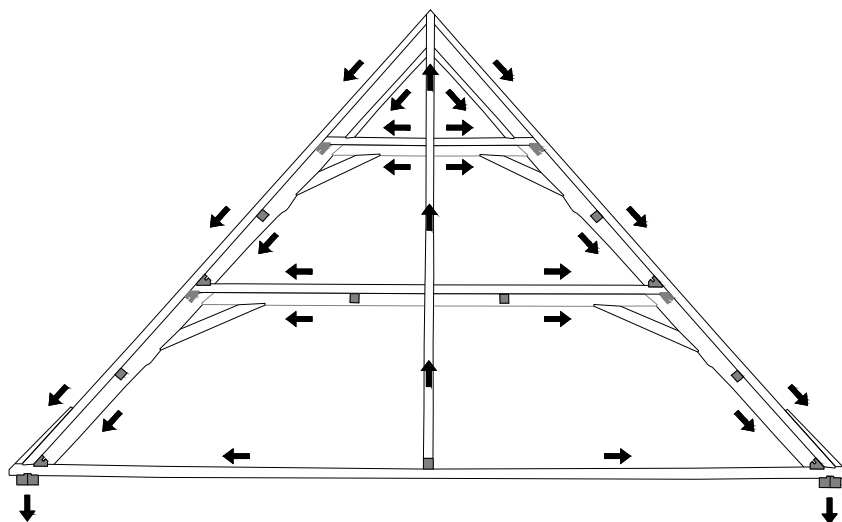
Lastabtragung nordöstliches Dachwerk
